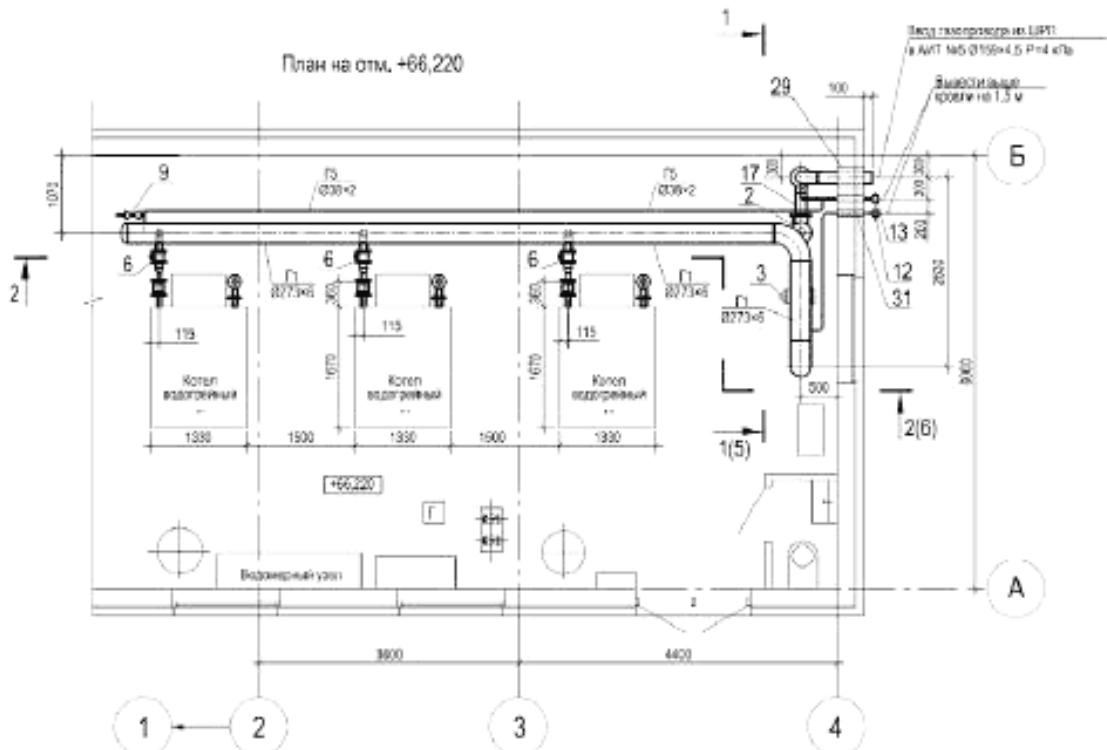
Пример выполнения плана расположения оборудования и газопроводов котельной
